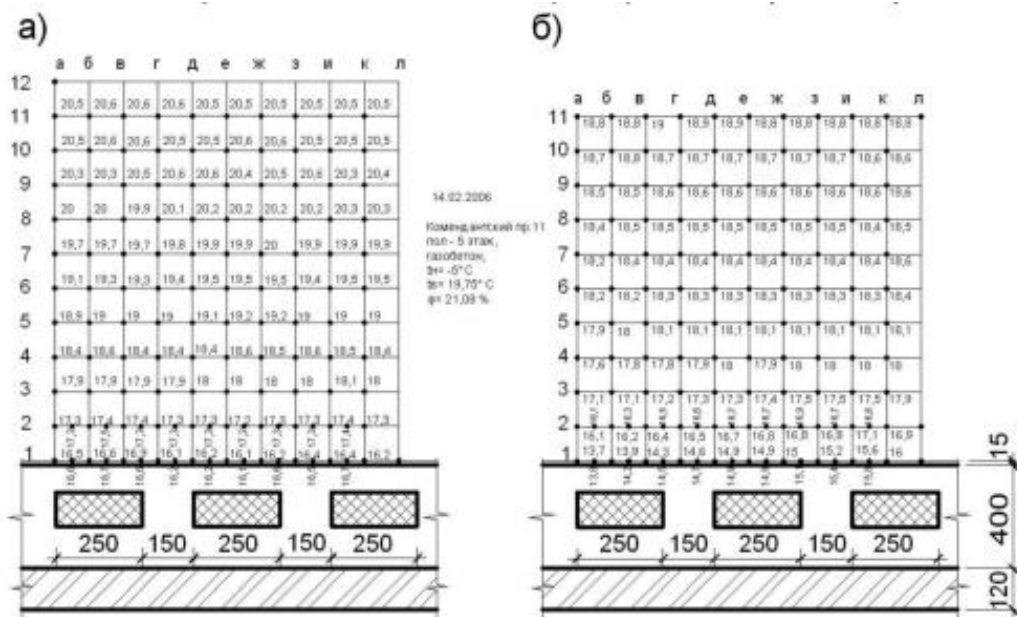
Розподіл температури на розглянутих поверхнях плити перекриття (тип 4): а) верхня грань плити перекриття (підлога); б) нижня грань плити перекриття (стеля)
